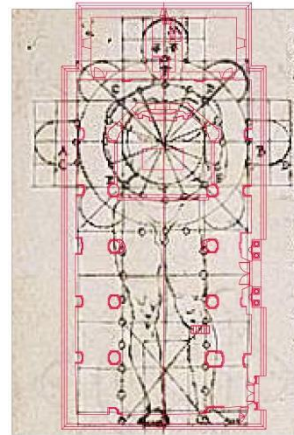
Planta del edificio sobre dibujo de Giorgio Martini.
